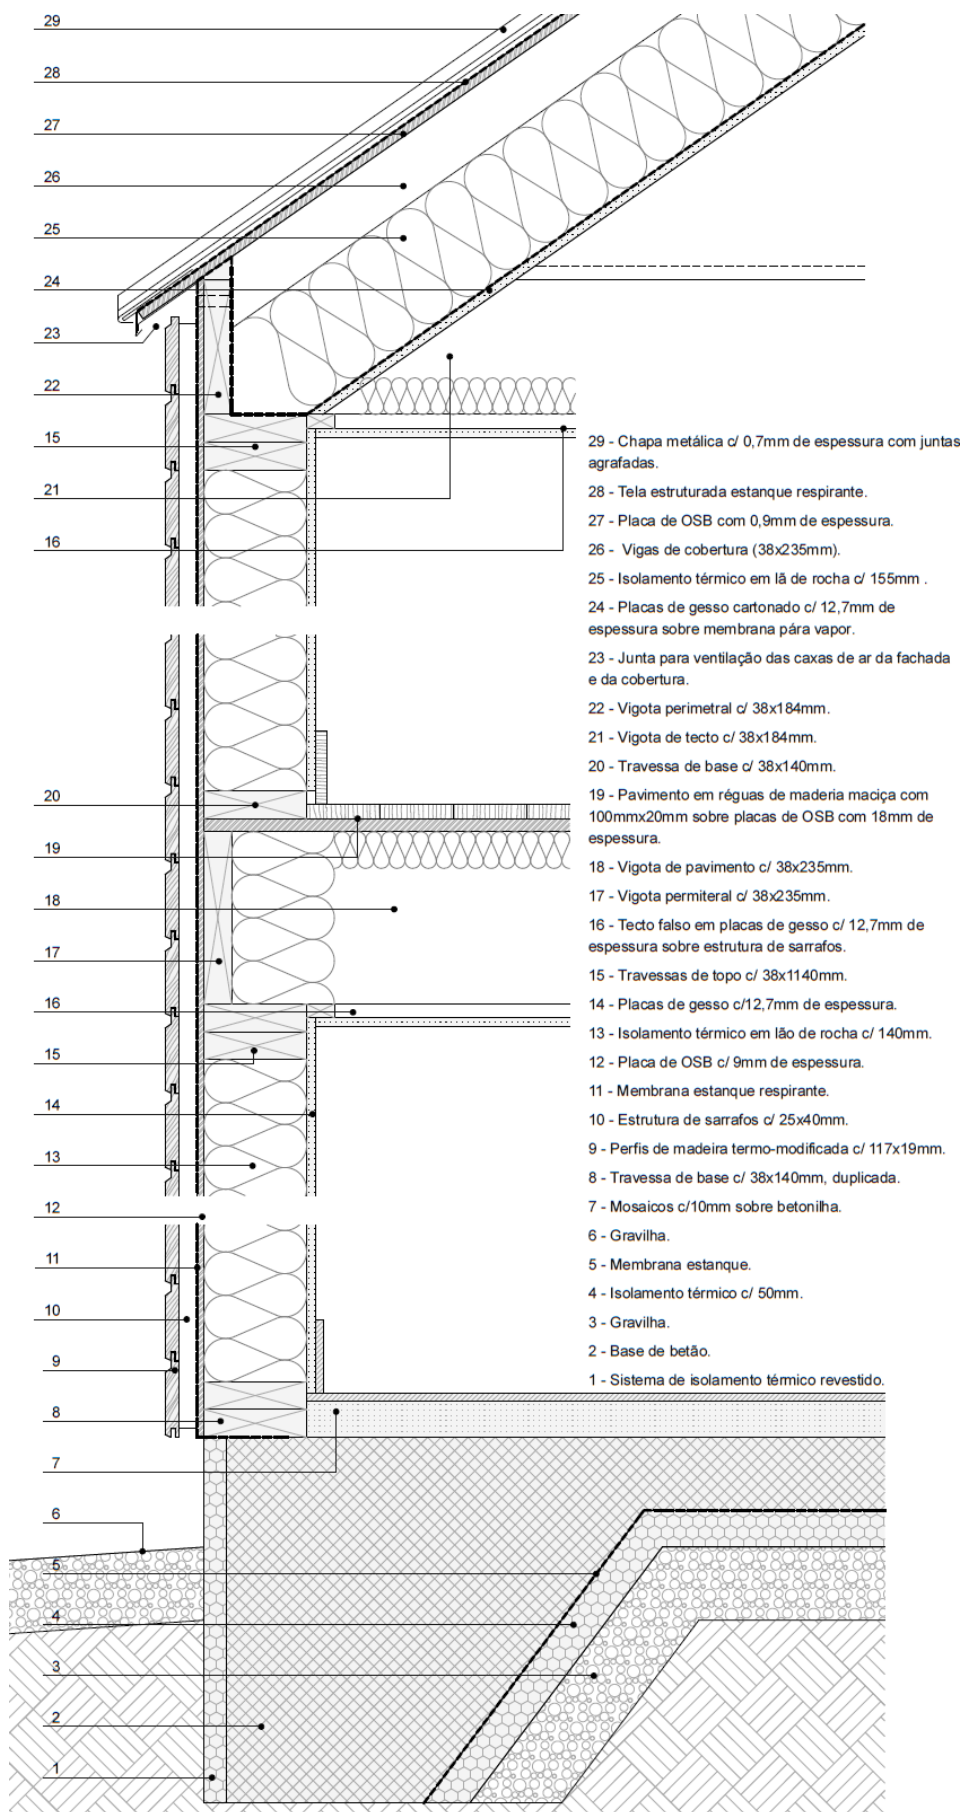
Corte construtivo pela fachada da solução com reticulados leve.
